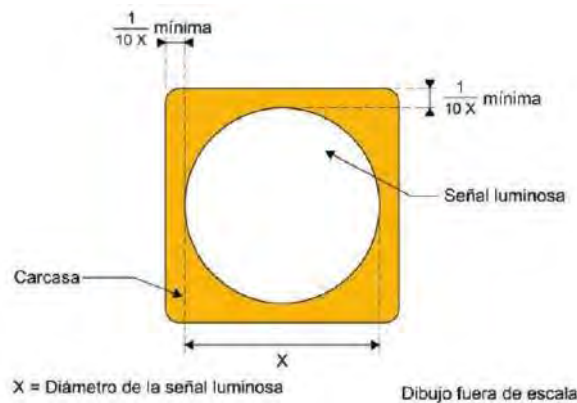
Dimensiones para el diseño de lentes en semáforos
